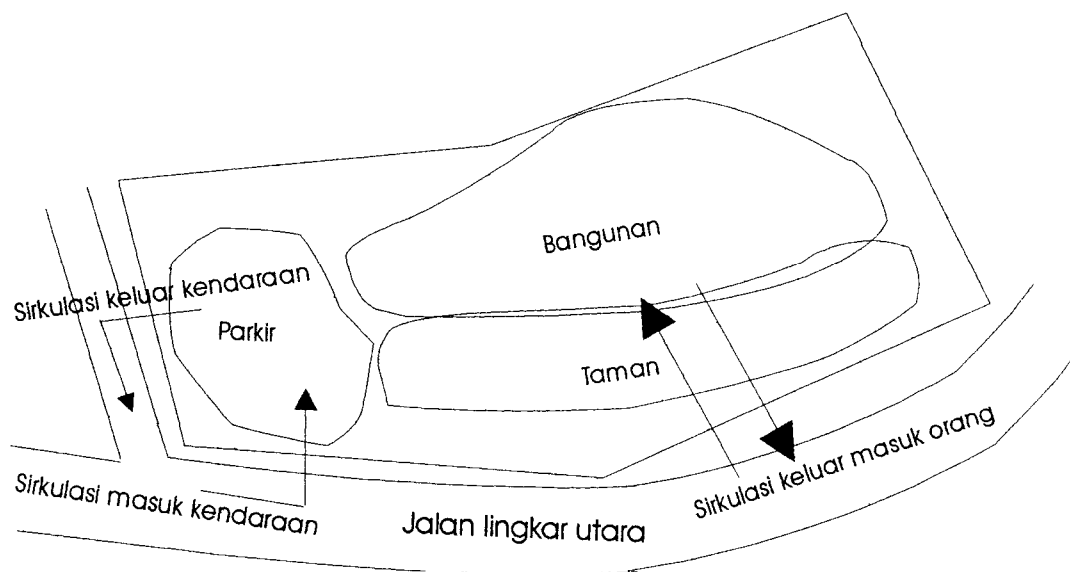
Zoning dan orientasi bangunan pada site.
